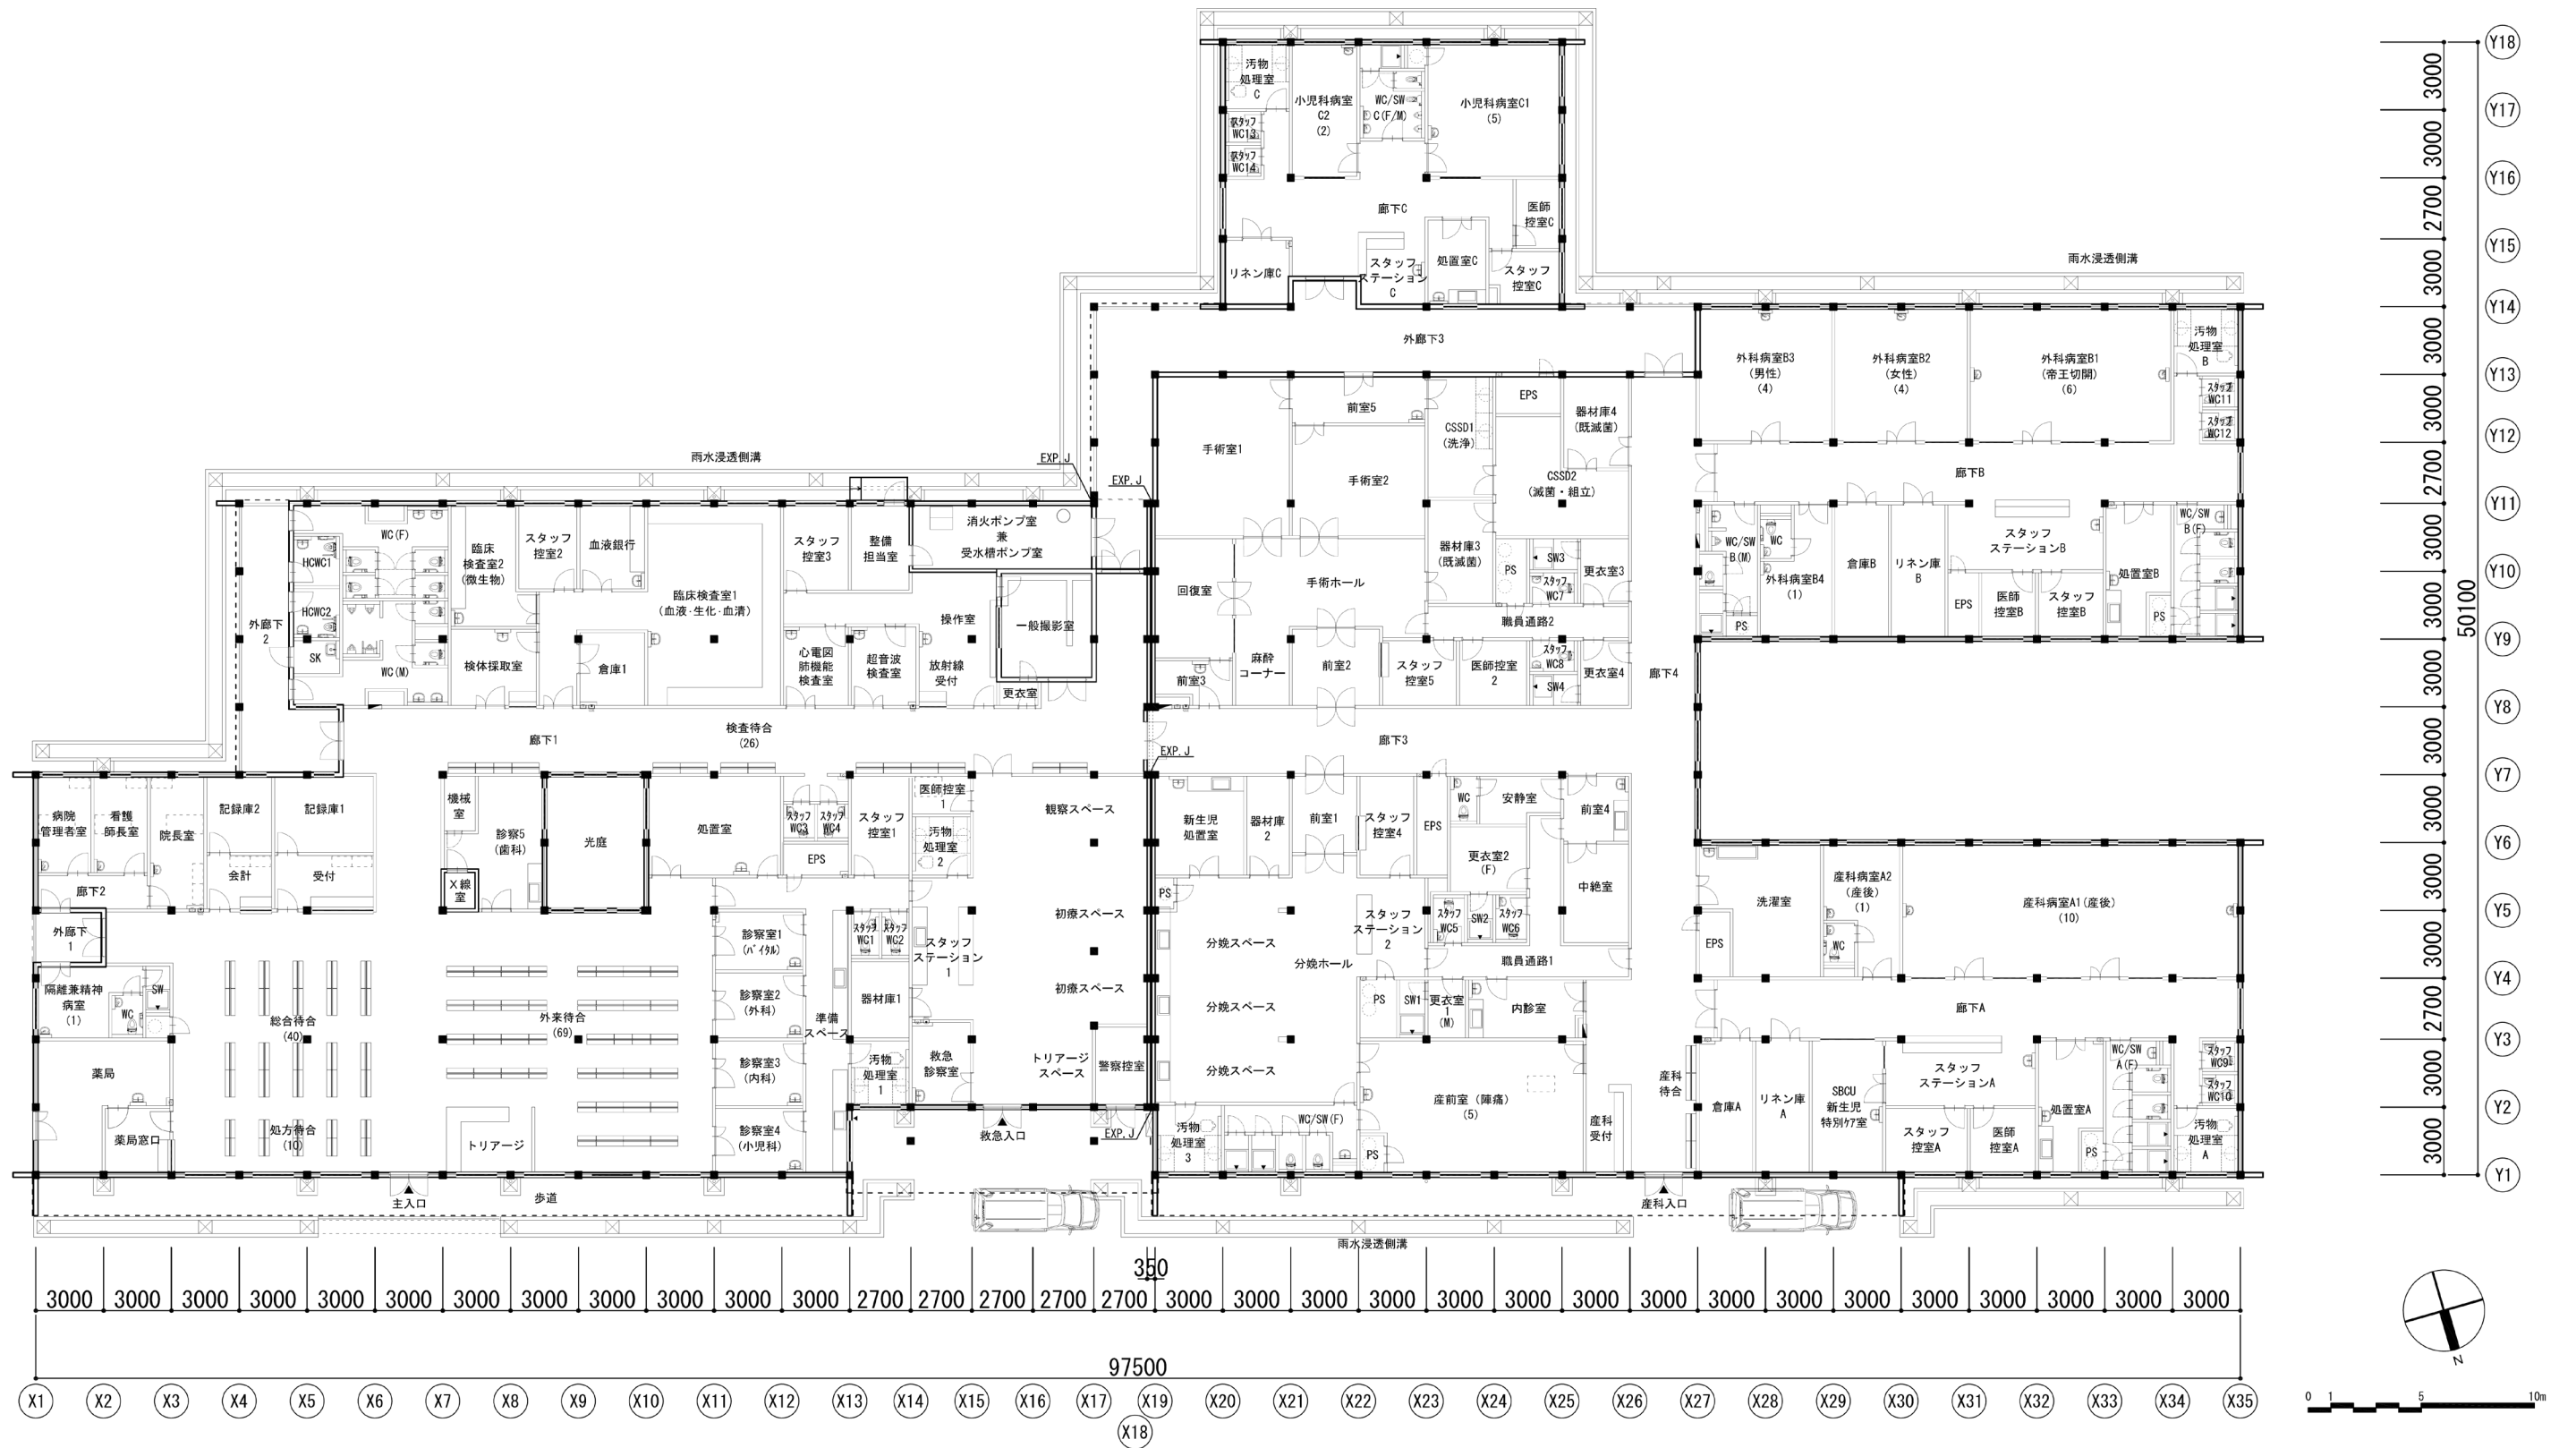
： ムシリー次レベル病院 1階 平面図 1/300
